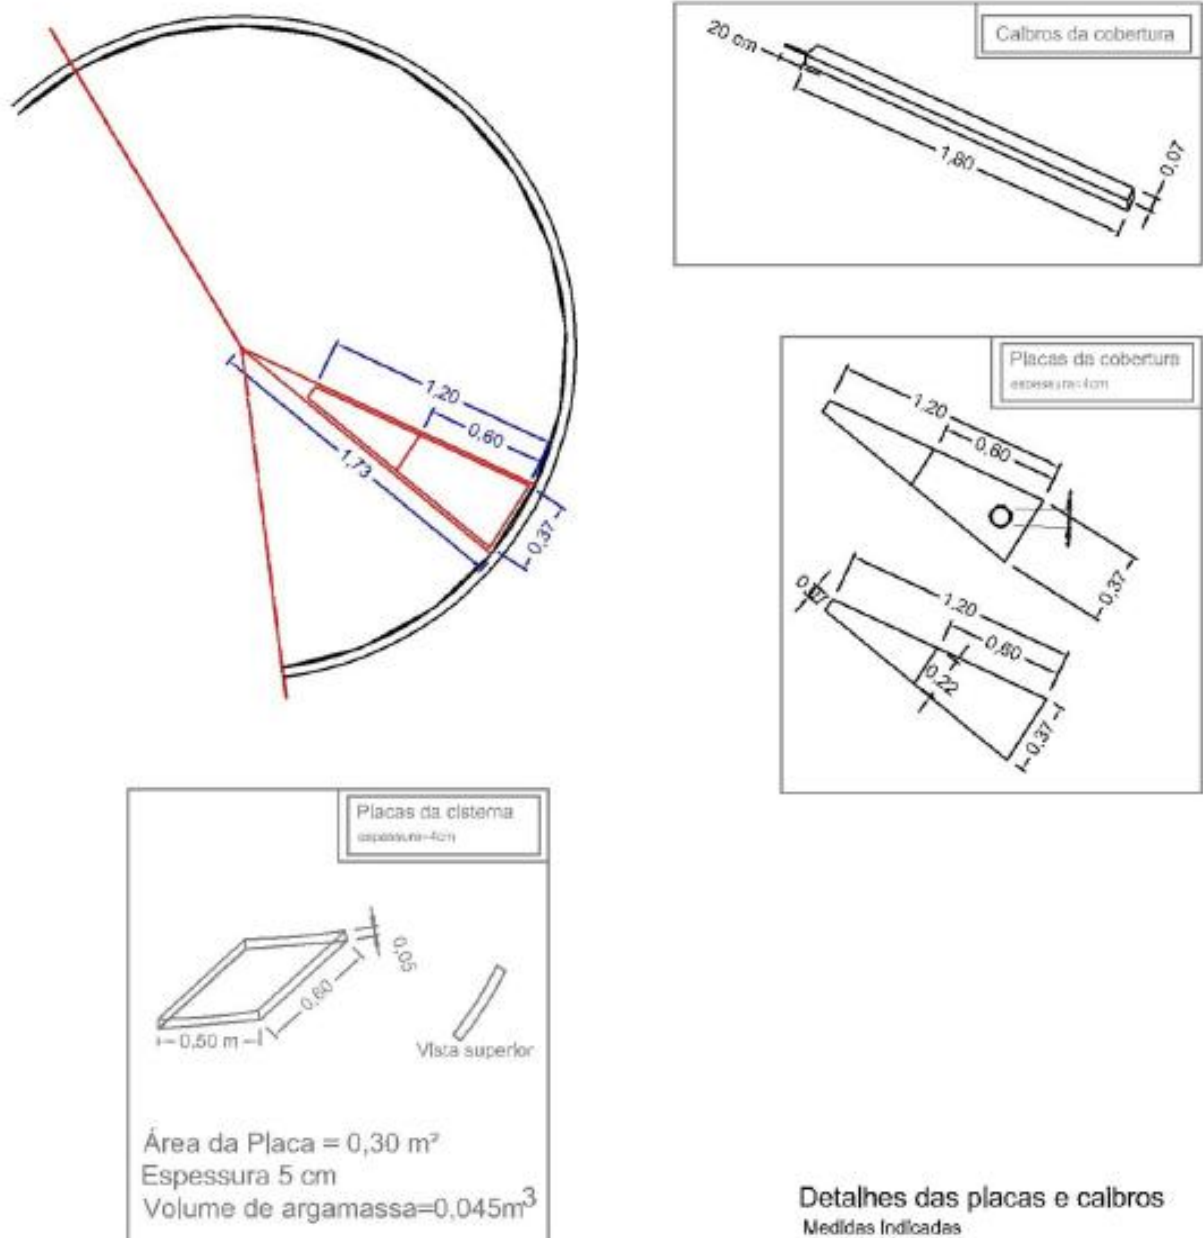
Detalle de placas y viguetas para una cisterna de 16000 litros (Ver apartado 5.1. Fuentes).
